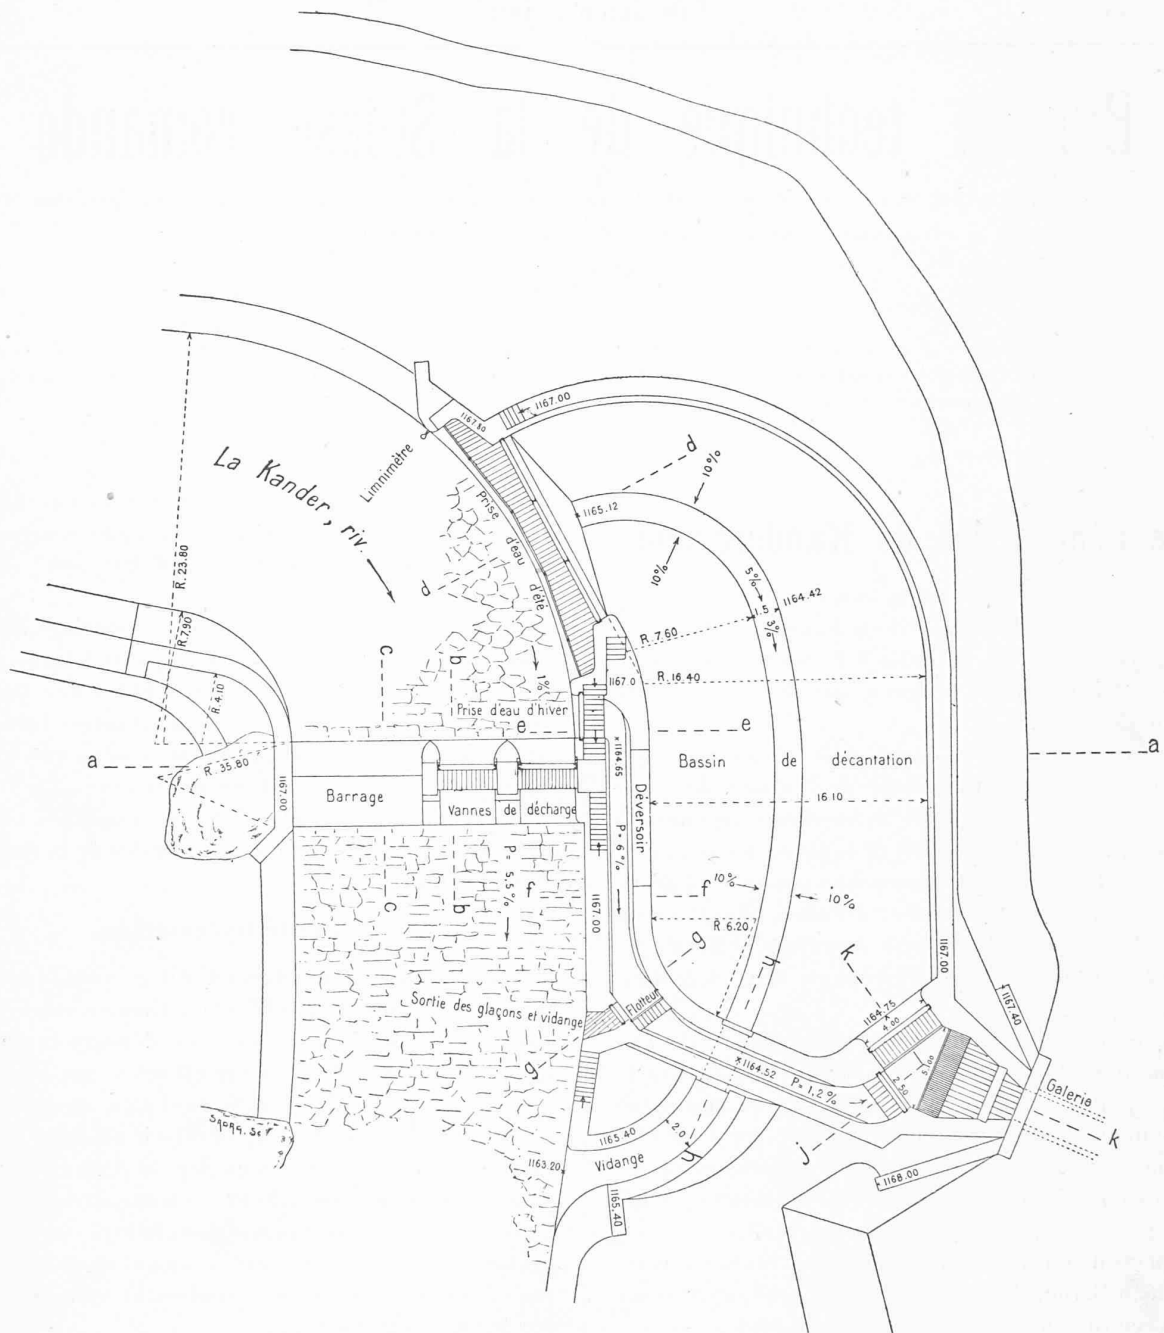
Plan de la prise d'eau. — 1 : 400.
